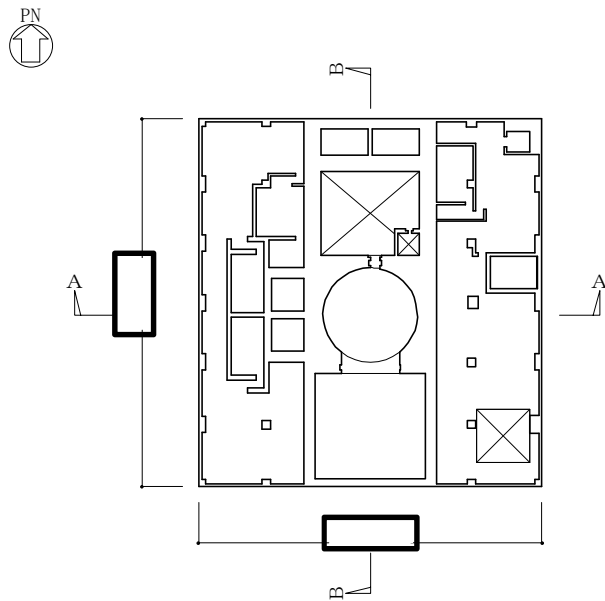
(8/10) 原子炉建屋の概略平面図 (EL. 38.8 m)
